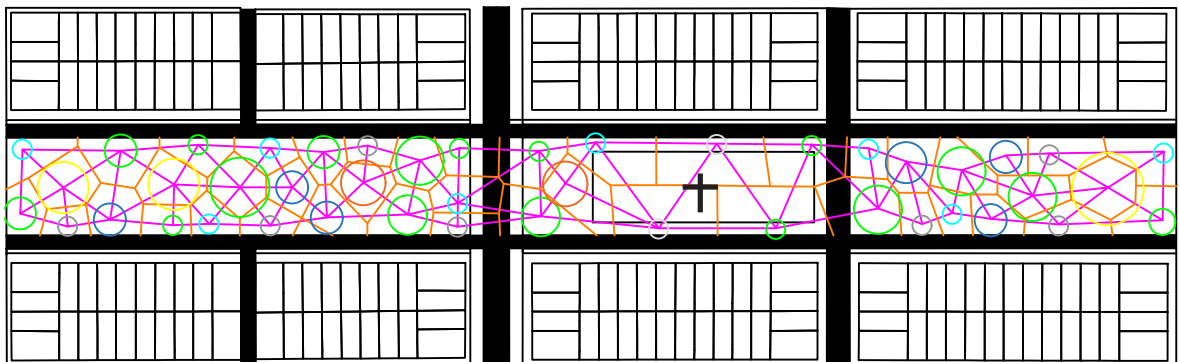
planimetría planta Parque lineal relación de espacios.
